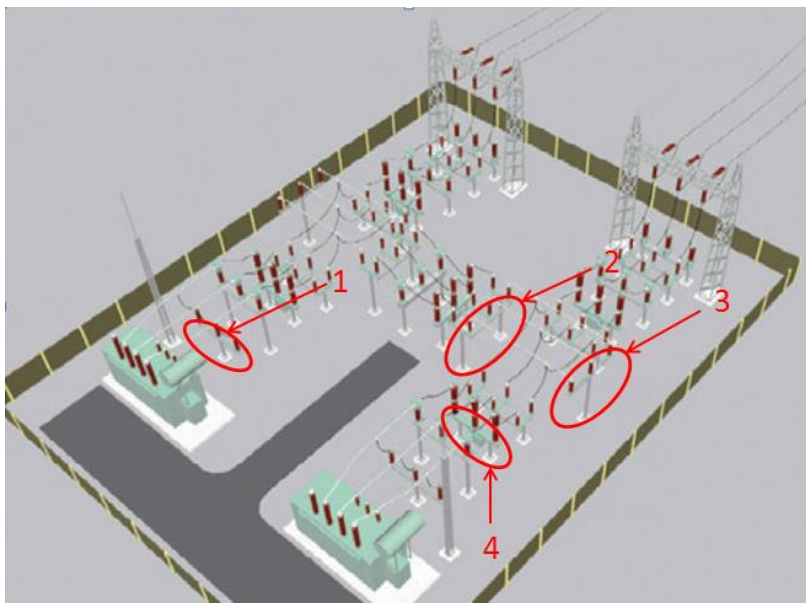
strutture d'acciaio e fondazioni per sottostazione in aria
